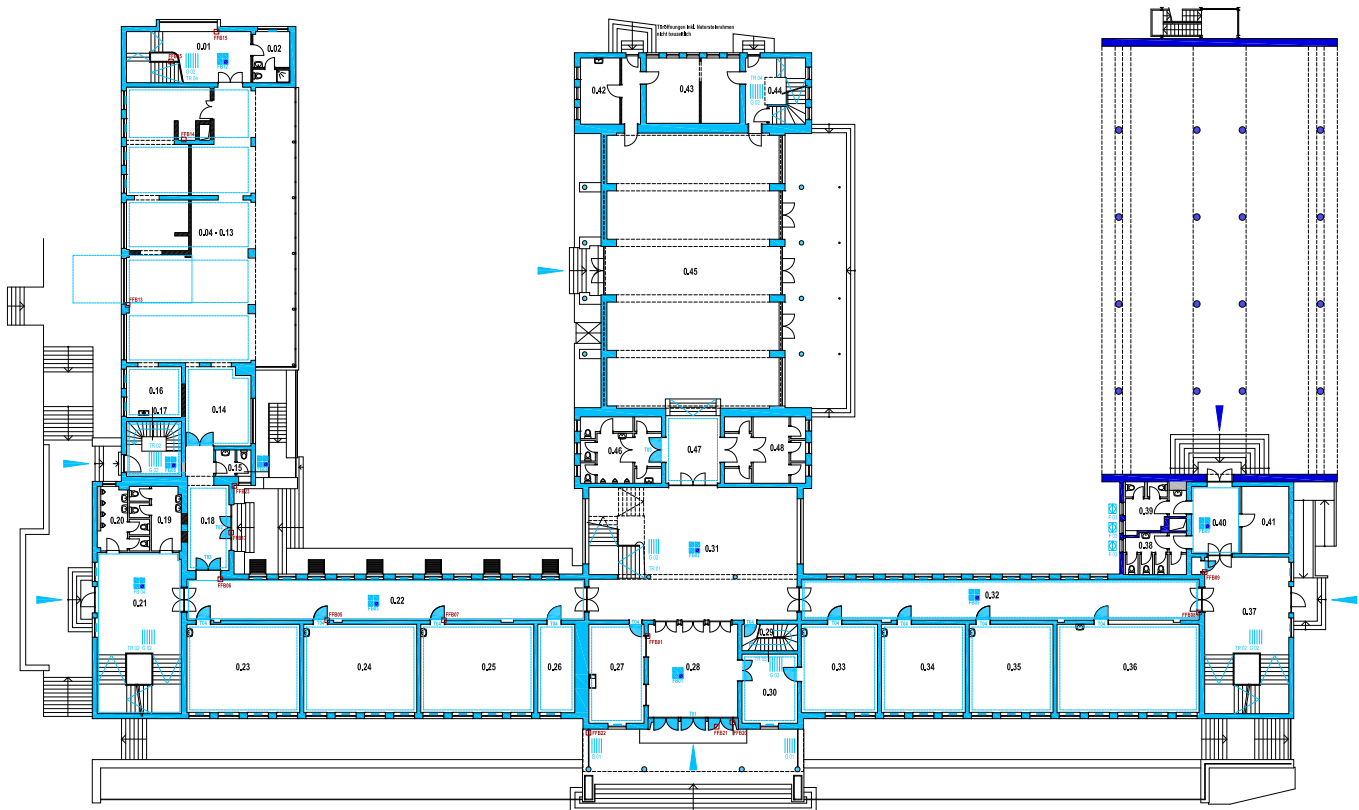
Bauphasenplan Erdgeschoss, Hellblau: 1956 / Dunkelblau: 1959 (2013)
